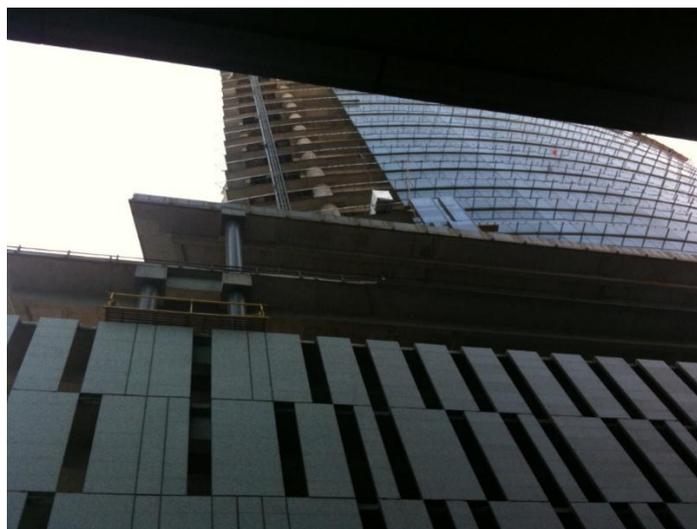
FIG. PP (En la foto se observa el sistema en una de las fachadas laterales).
